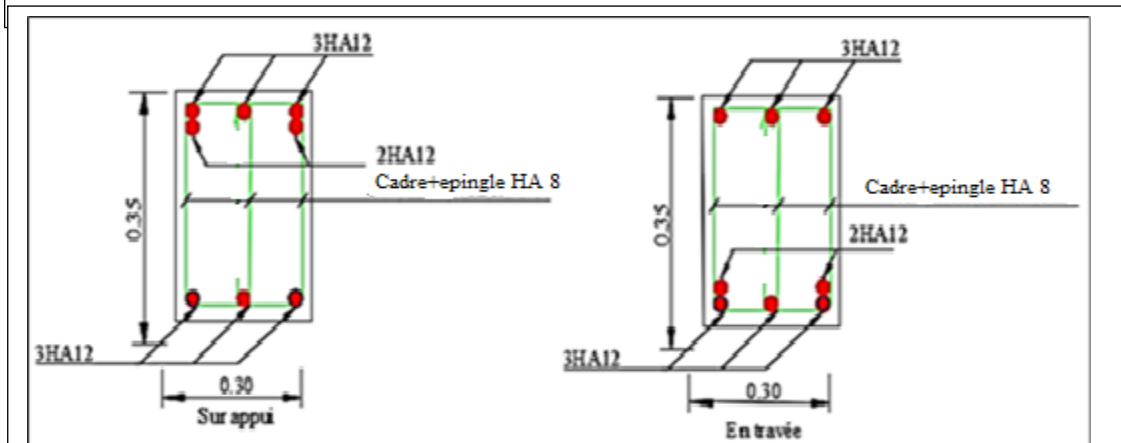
Schéma de ferrailage des poutres secondaires.
